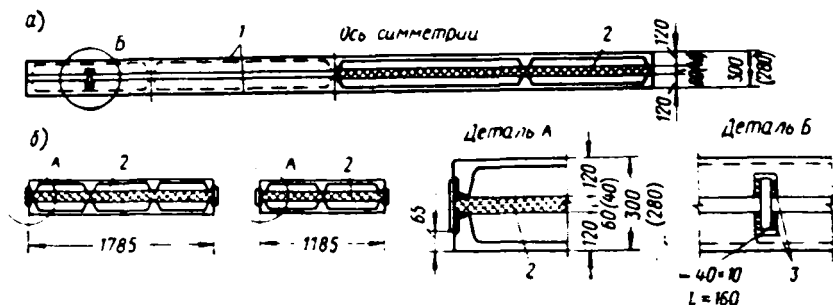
Типовая трехслойная стеновая панель длиной 6 м
